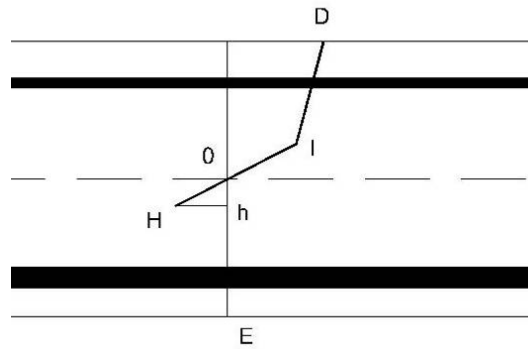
Diagrama de tensiones del hormigón armado propuesto por Von Thullie. (Marv, 1902)
